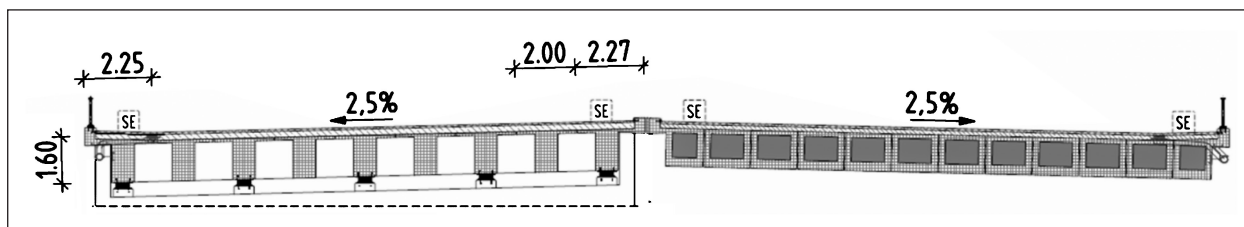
Spannbetonplattenelemente, mit Ortbetonerfüllung und integriertem Gesims
